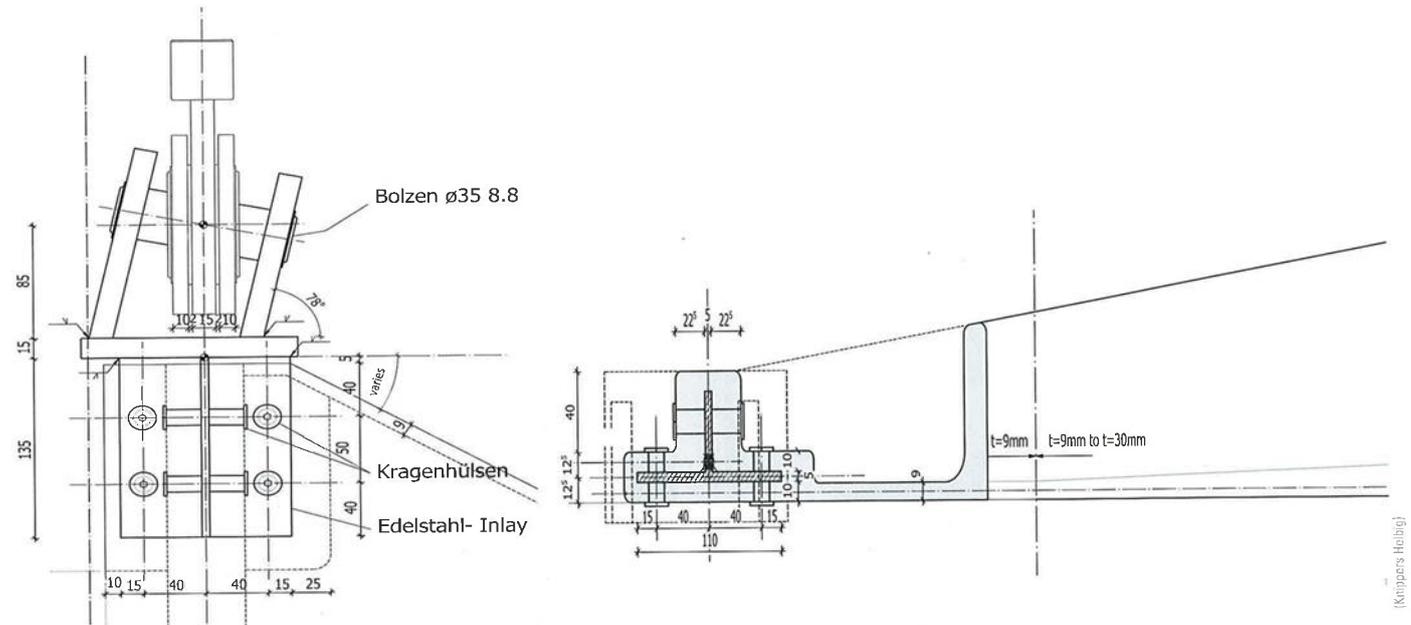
Anschlussdetail „Oberkante Lamelle an Aktuator“
